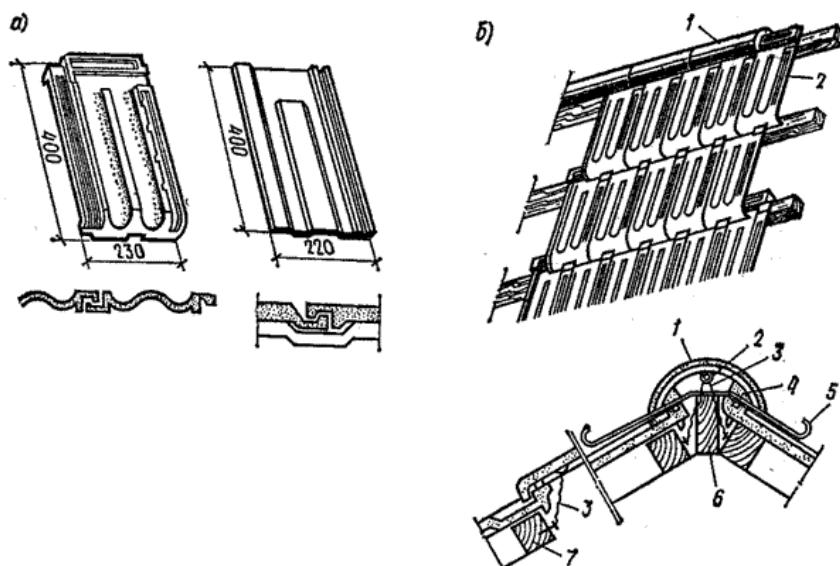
Кровля из черепицы: а – черепица; б – общий вид кровли из черепицы;
